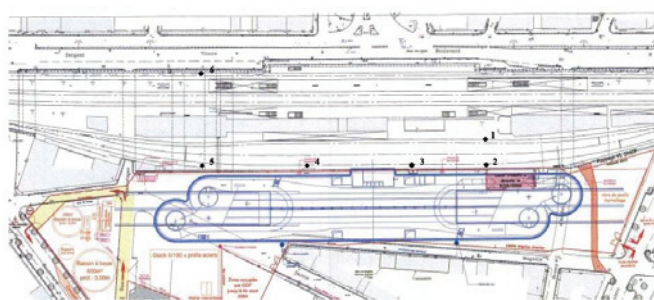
Vue générale du parking et du viaduc SNCF
